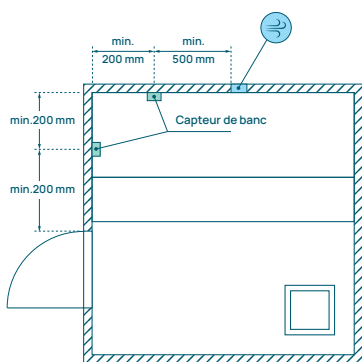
Installation du capteur de banc sur le mur du côté/de l'angle opposé au chauffage
